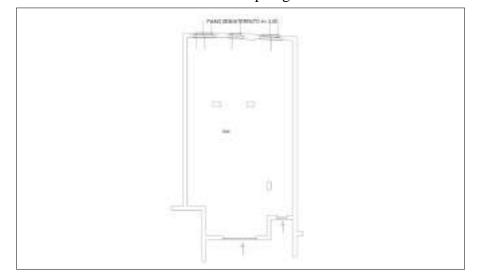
Planimetria dell'appartamento posto al piano terra sub 28
